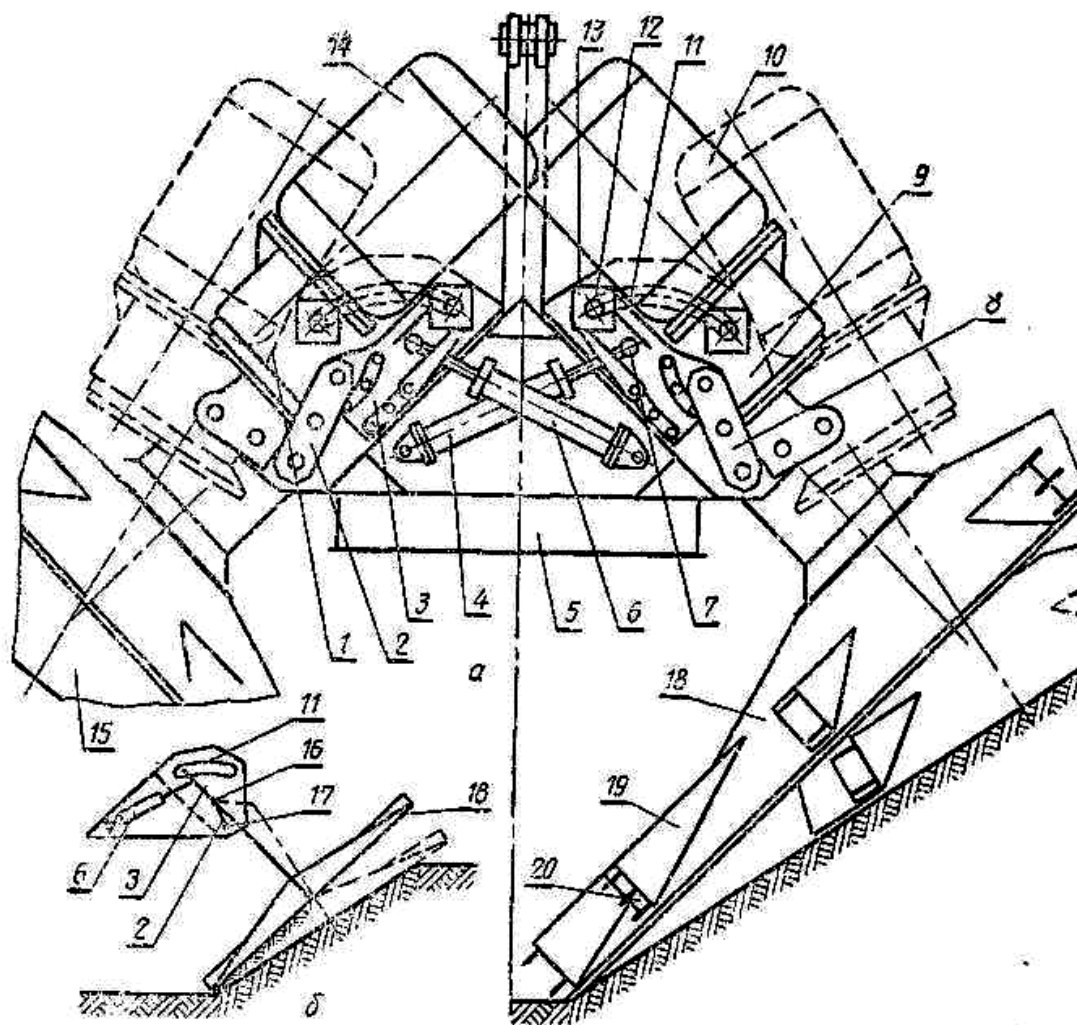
Двухфрезерный рабочий орган каналокопателя с дизель электрическим приводом, с переменным углом наклона фрез:
